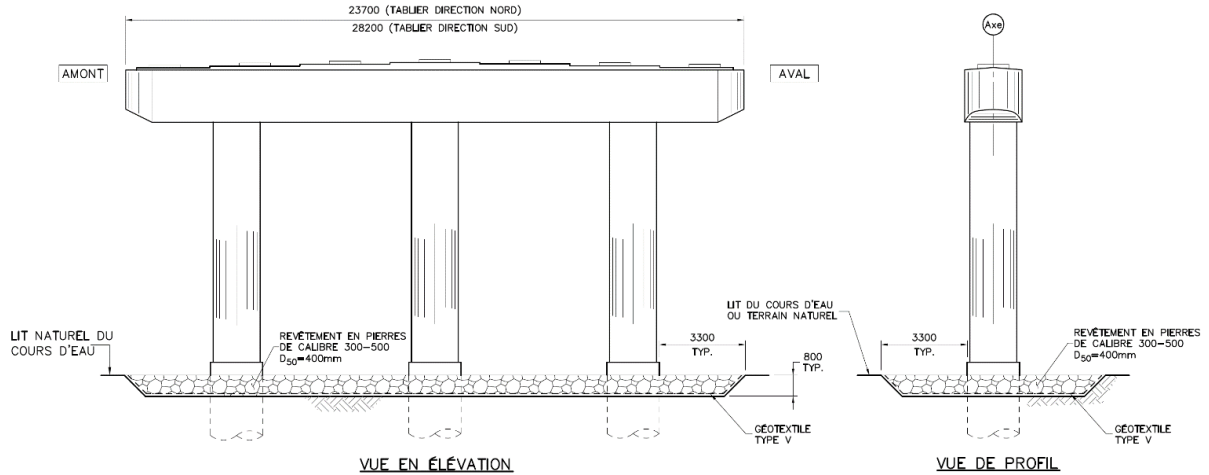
Coupes en élévation et en profil de l'enrochement de protection des piles
